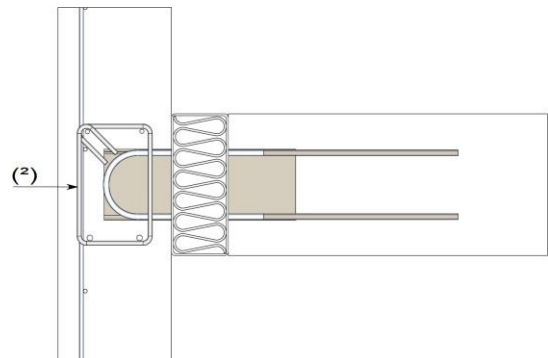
Chainage de mur – liaison dalle – façade - disposition 2 (vue en coupe)
